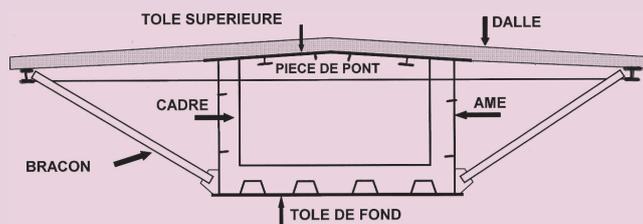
Caisson à pièces de pont et bracons (cas d'une chaussée à dévers en toit)
